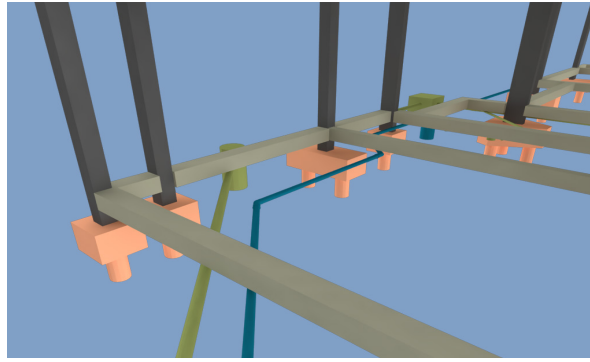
Visualização tridimensional do lançamento sanitário externo - Vista 2
